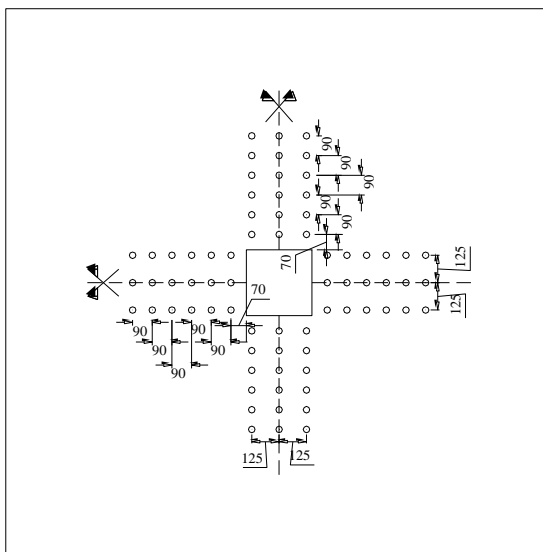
Posição dos furos - Laje LC-S2-6
